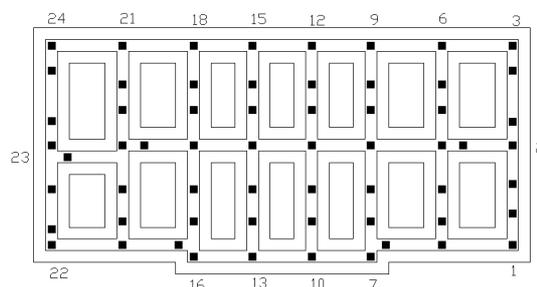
Схема фундамента и расстановка домкратов (цифрами обозначены марки на фундаментной ленте)
